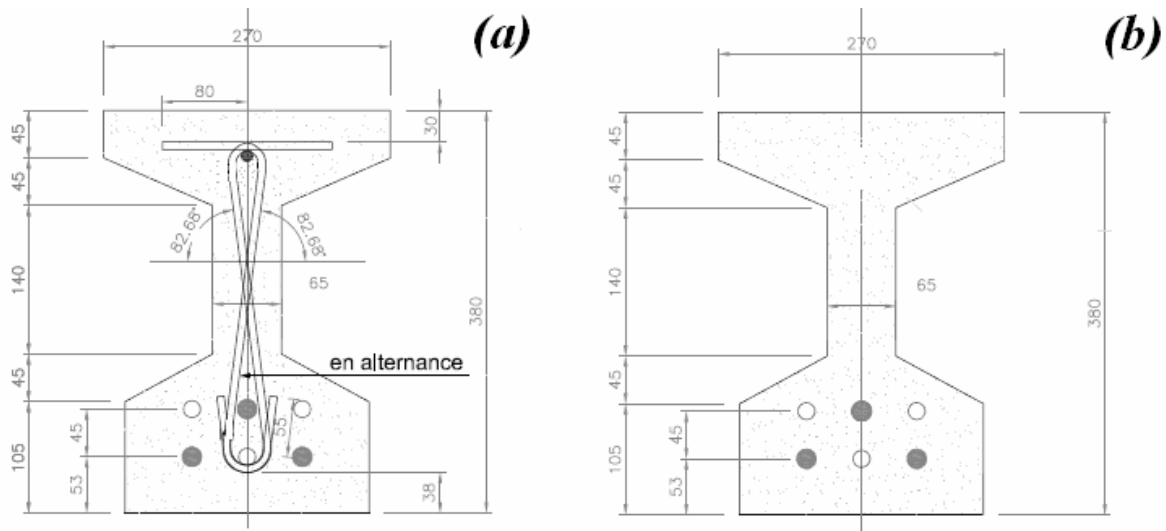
Section des poutres précontraintes (dimensions en mm) : (a) poutres avec armatures transversales ; (b) poutres non armées transversalement (Armatures longitudinales : 6 torons T15S, Armatures transversales : 1 HA 6 tous les 7,5 cm).
